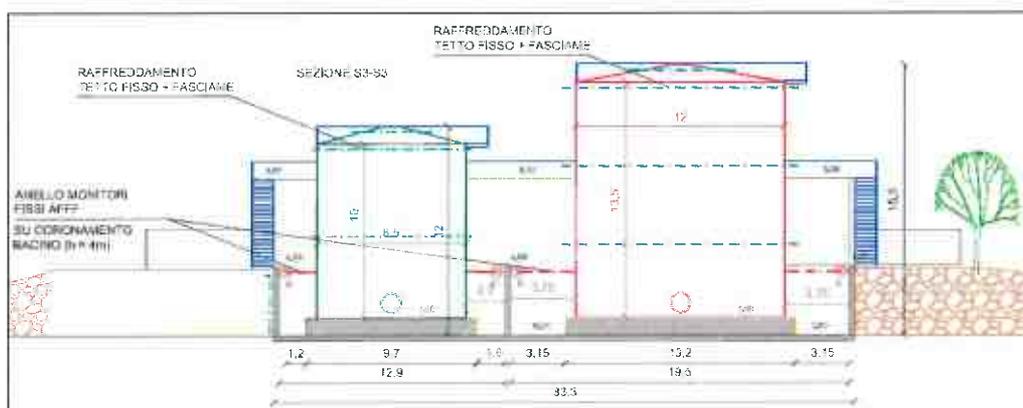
Prospetti di progetto (da Elab. T10 allegato allo SPA)
